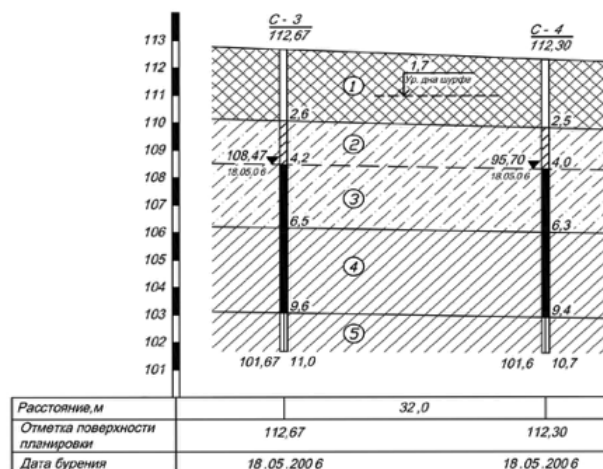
Инженерно-геологический разрез строительной площадки реконструируемого здания:
